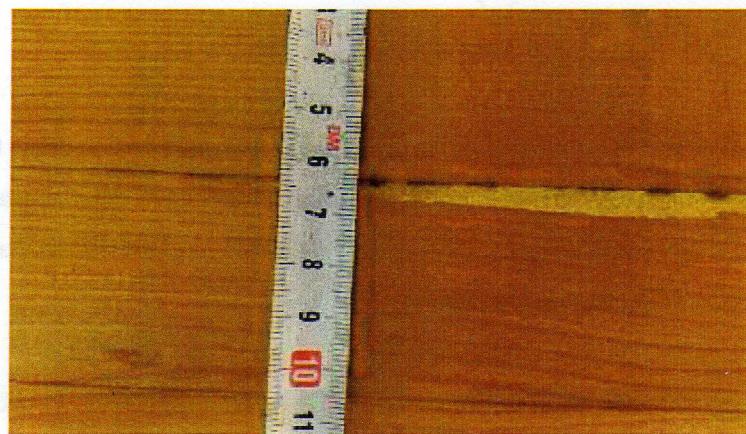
Deterioro de junta entre componentes de madera laminada en viga de sala gimnasio.
